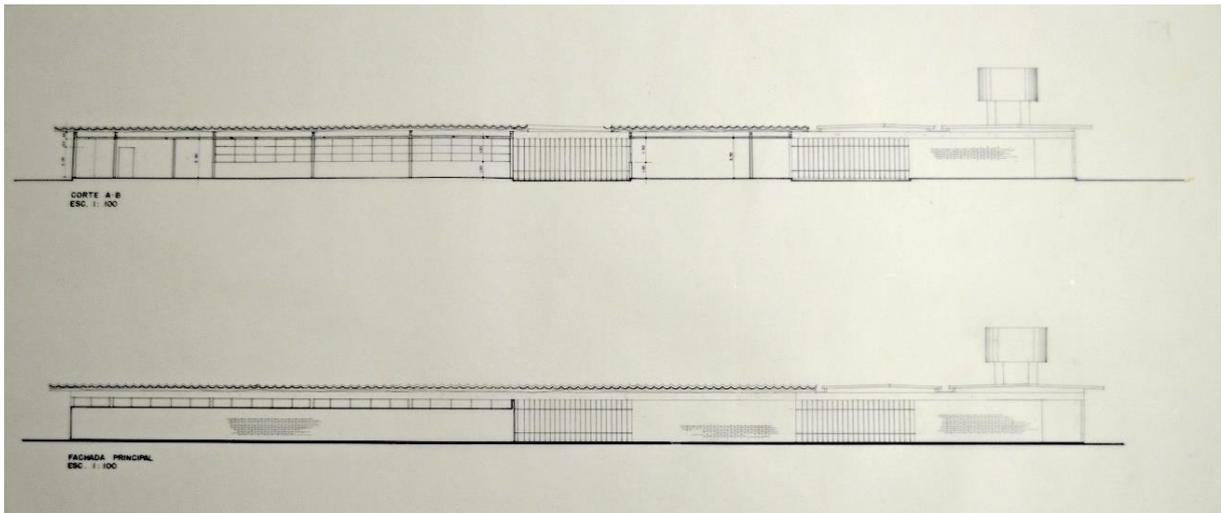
Corte A-B e Fachada do bloco Creche, proposta de abril de 1982.
